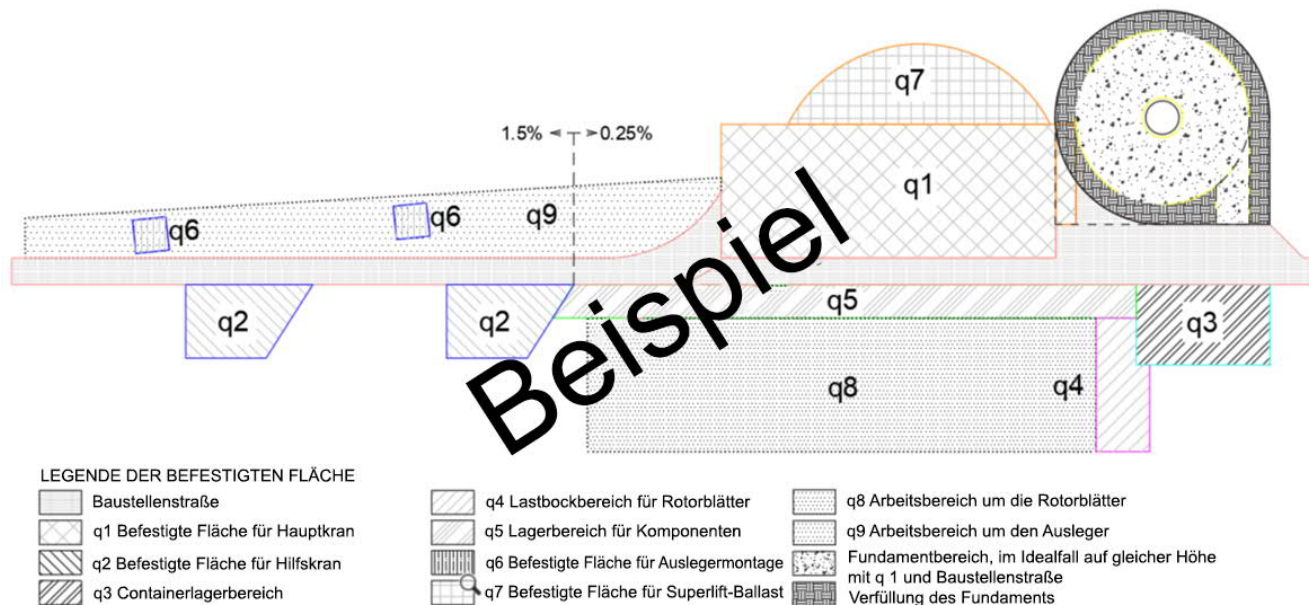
Beispiel für den Grundriss eines Baubereichs.
